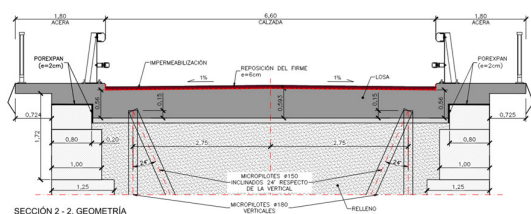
Esquema de disposición de micropilotes en alzado de estribos.
